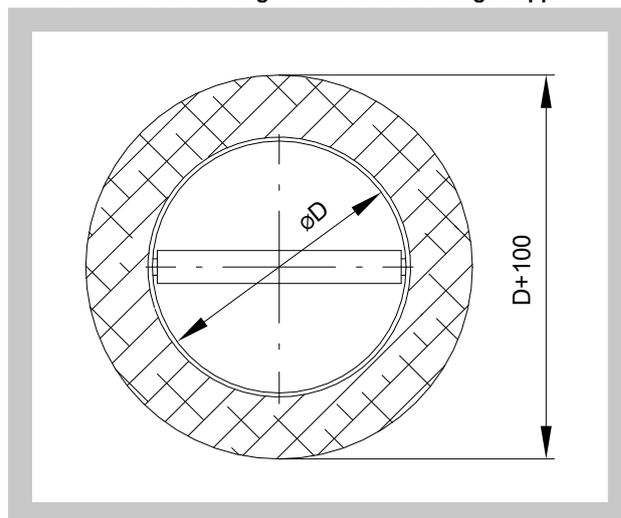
Bauöffnung - runde Entrauchungsklappe
